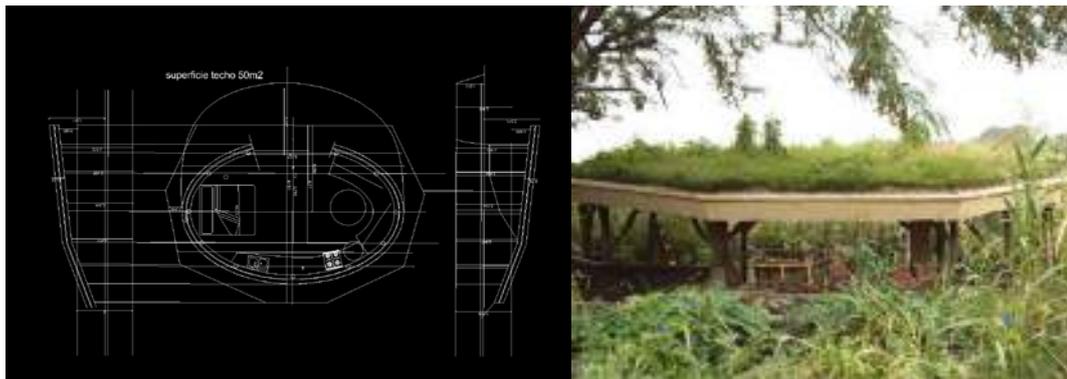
Planta y vista de casapozo 2012 (acervo Hombre de Barro)
